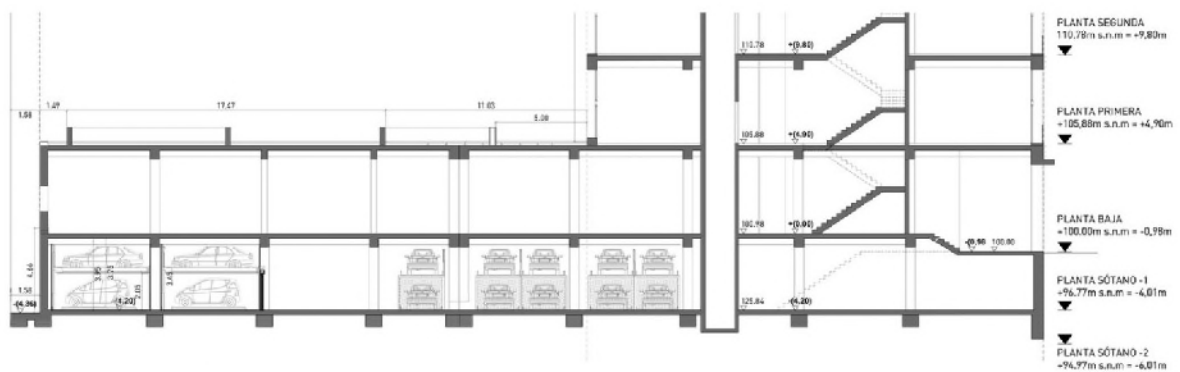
Sótano -1. Sección longitudinal por núcleo de escaleras y ascensor. En la zona oeste se destina a aparcamiento semirobotizado con baterías de doble aparcamiento en altura, posible a la altura libre de 3,95 metros
